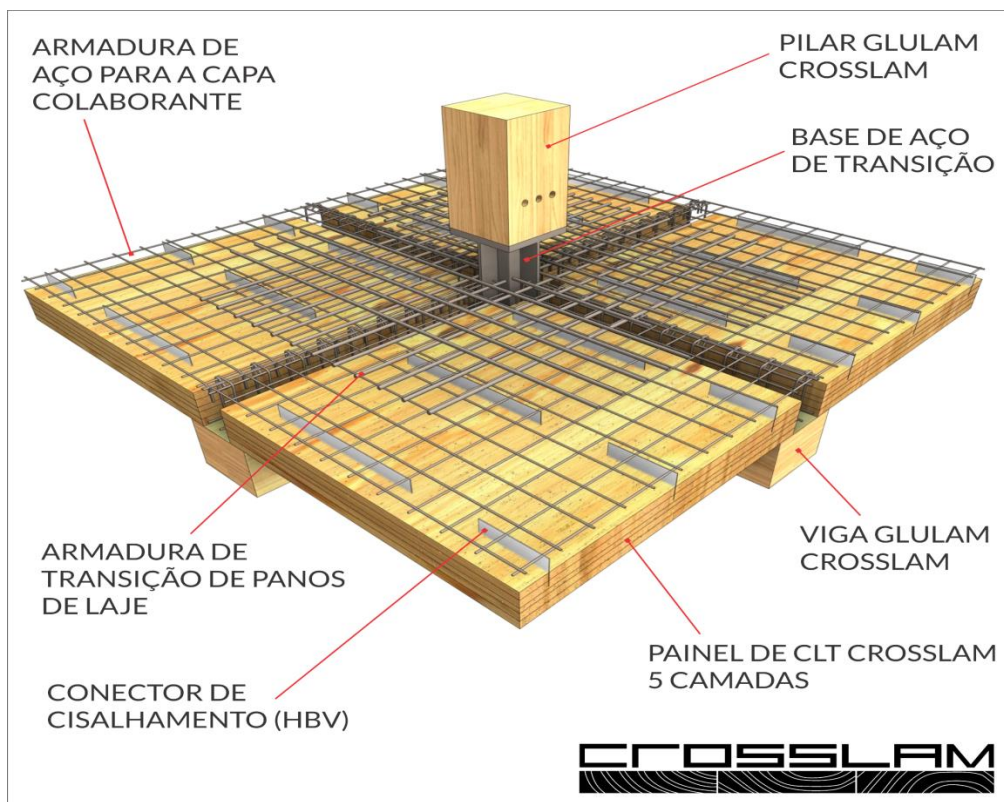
Estrutura de Laje Mista de Madeira-Concreto
